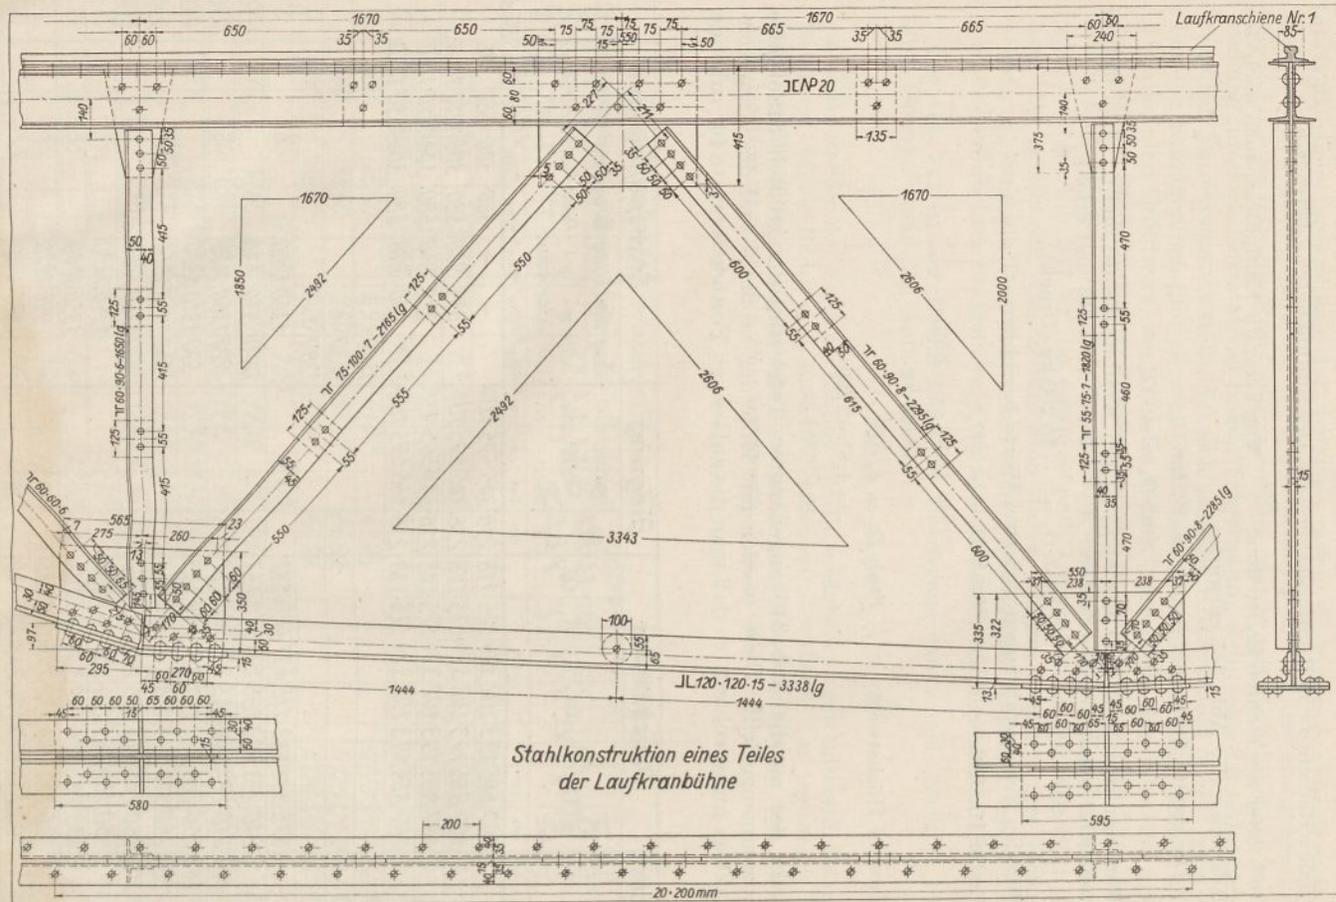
Stahlbauzeichnung eines Teiles der Laufkranbahn.
